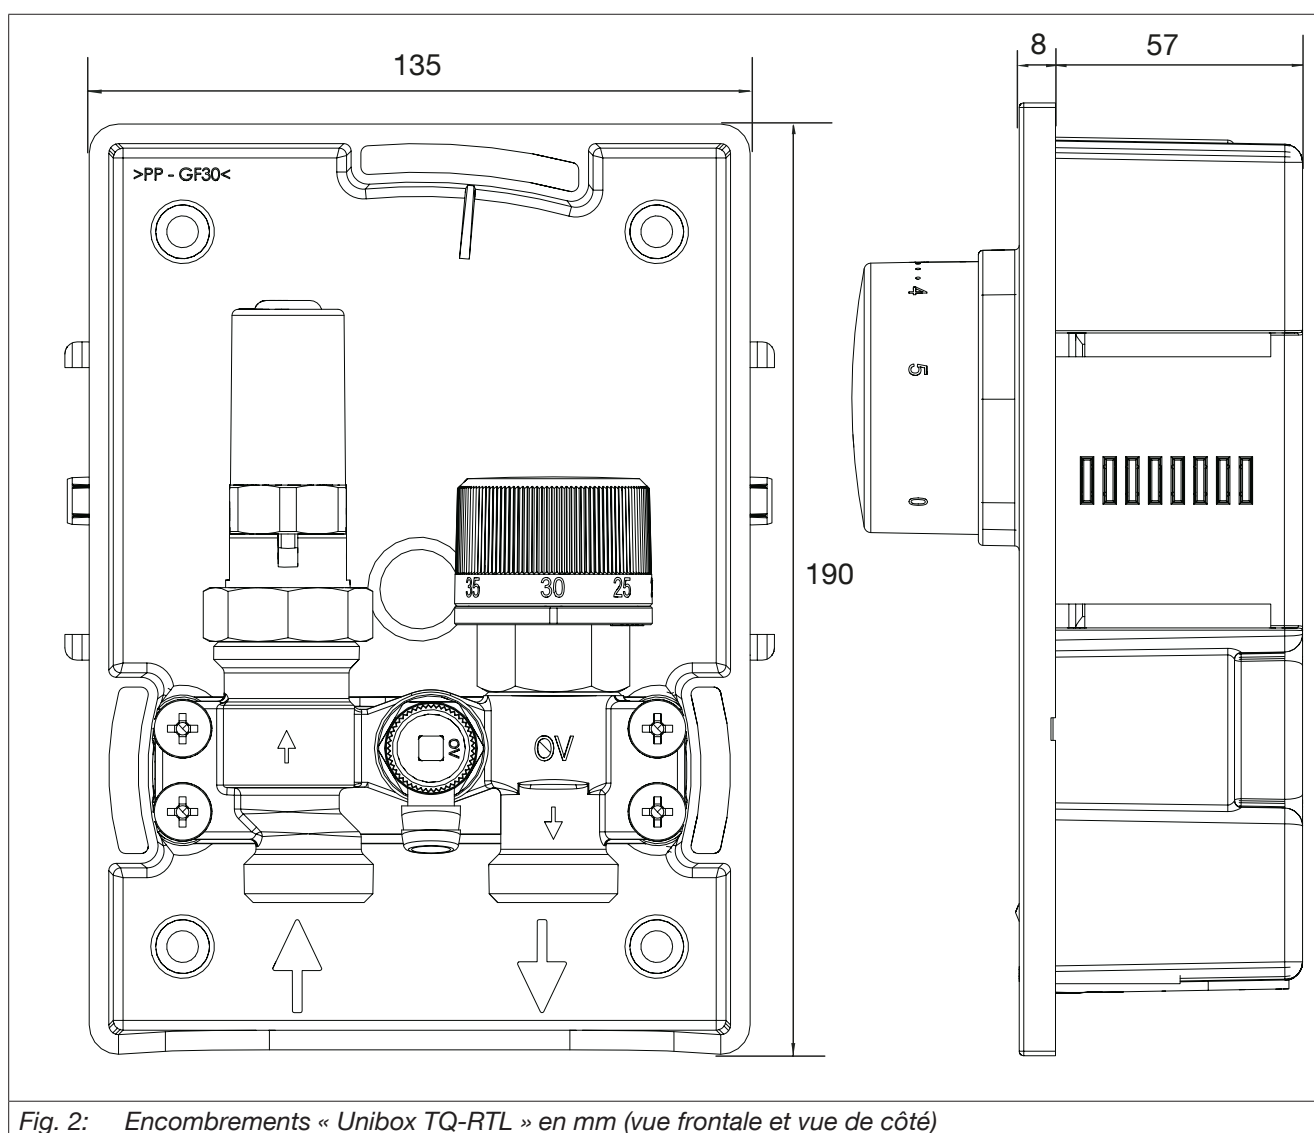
Encombrements « Unibox TQ-RTL » en mm (vue frontale et vue de côté)
